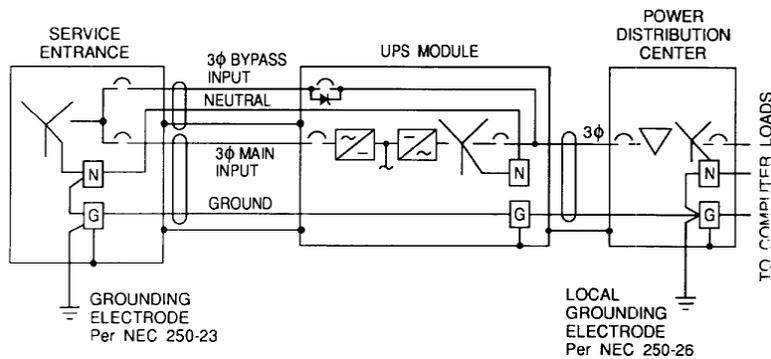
Configuración 3: UPS-bypass no aislado centro de distribución aislado “Y”<sup>103</sup>
